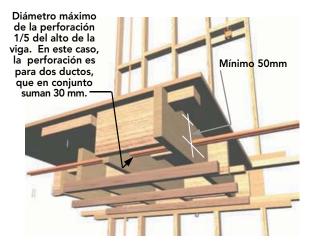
Plataforma de entrepiso que tiene perforadas las vigas secundarias.
